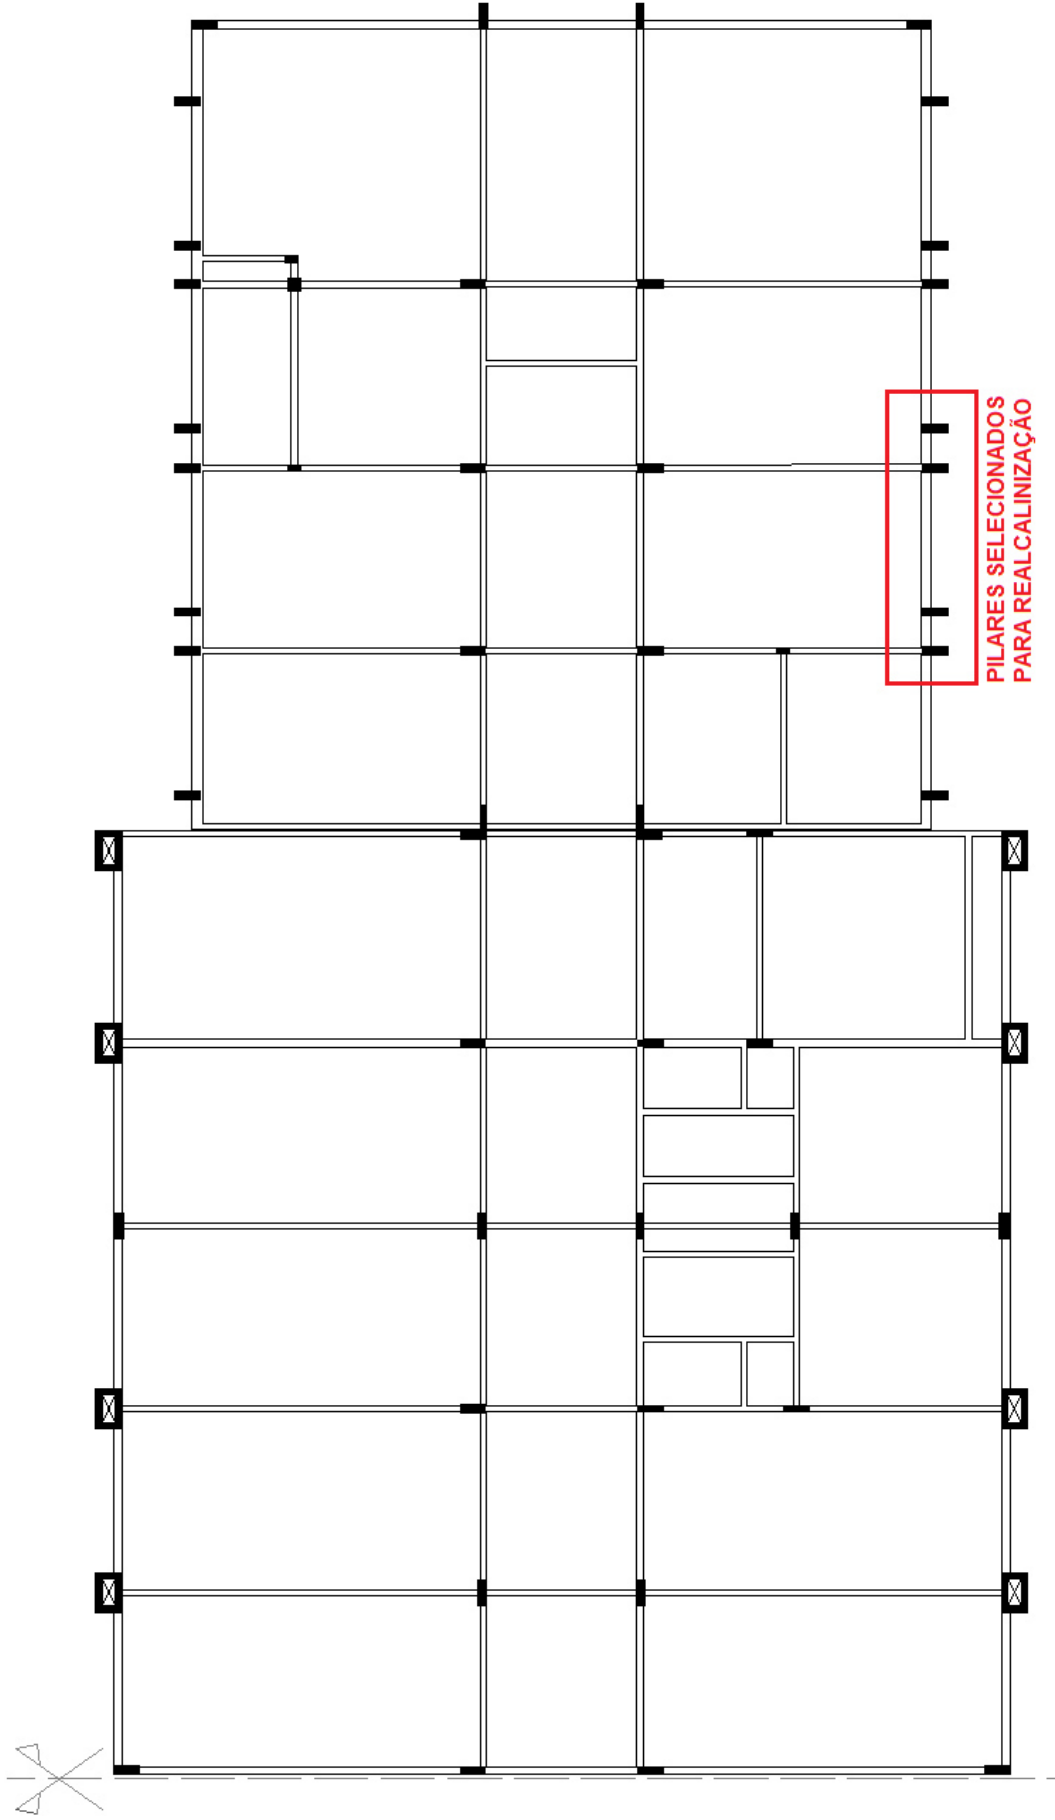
Croqui da estrutura e localização dos pilares selecionados para a realização.
